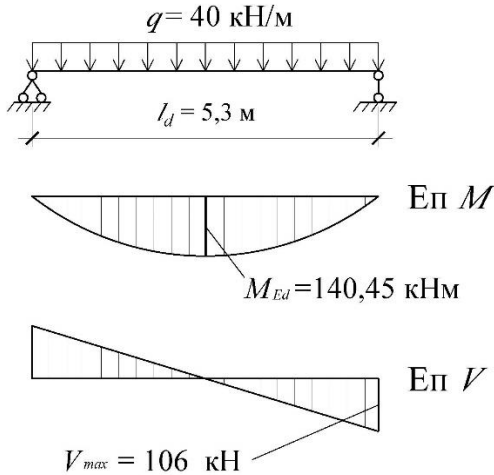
Розрахункова схема прогону та епюри внутрішніх зусиль
